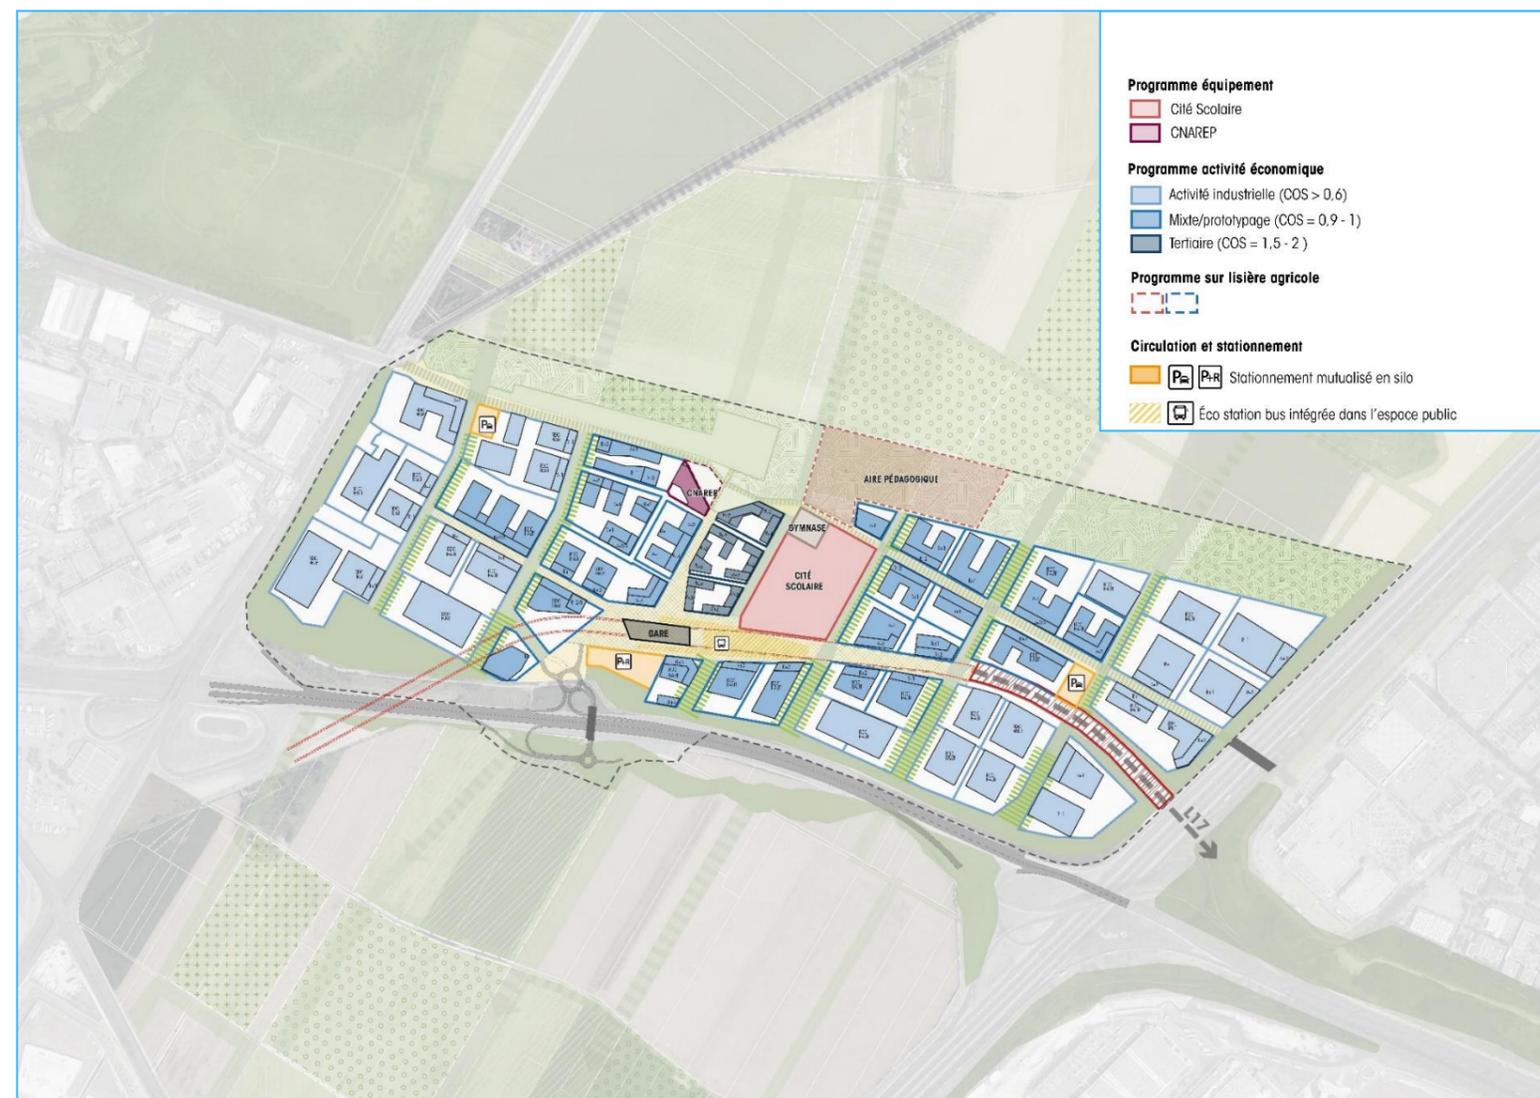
Plan du bâti des lots privés au stade du plan guide d'aménagement (Source : HDZ)
